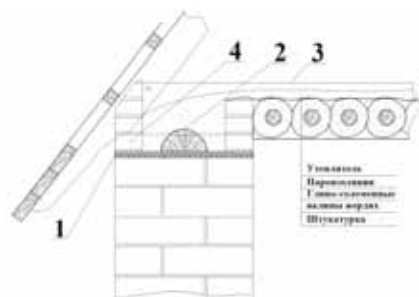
Устройство чердачного перекрытия: 1 – гидроизоляция; 2 – обвязка из пластин по периметру здания; 3 – балка перекрытия; 4 – закладка между балками керамическим кирпичом
